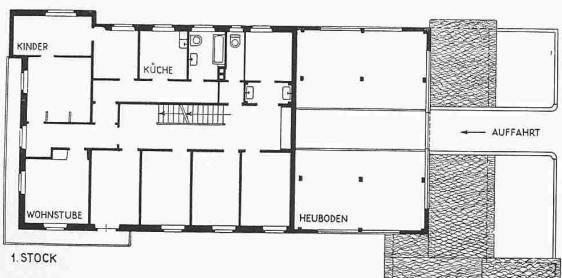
bis 28. Oekonomie, Grundrisse 1:400
